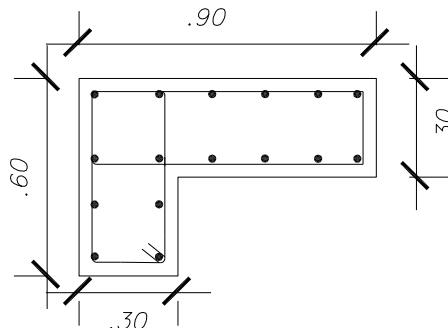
Acero distribuido en la estructura de la columna 3ª.
